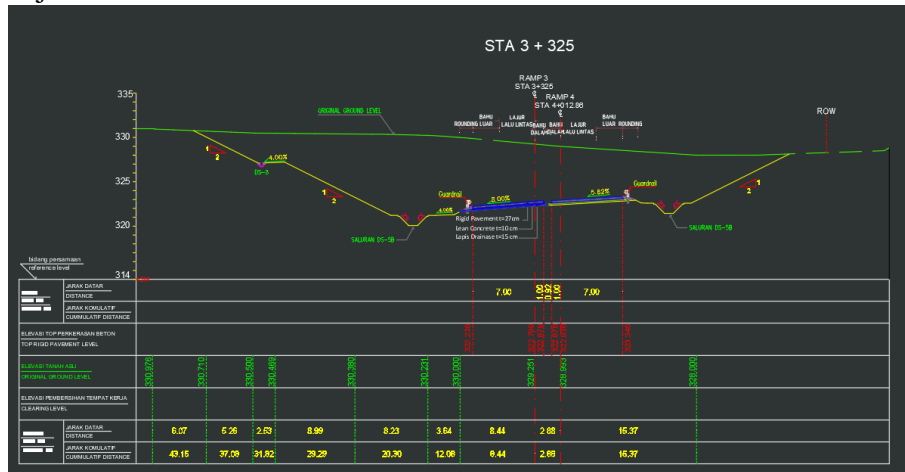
Perhitungan Volume Total Lean Concrete Ramp 1 hingga Ramp 4
